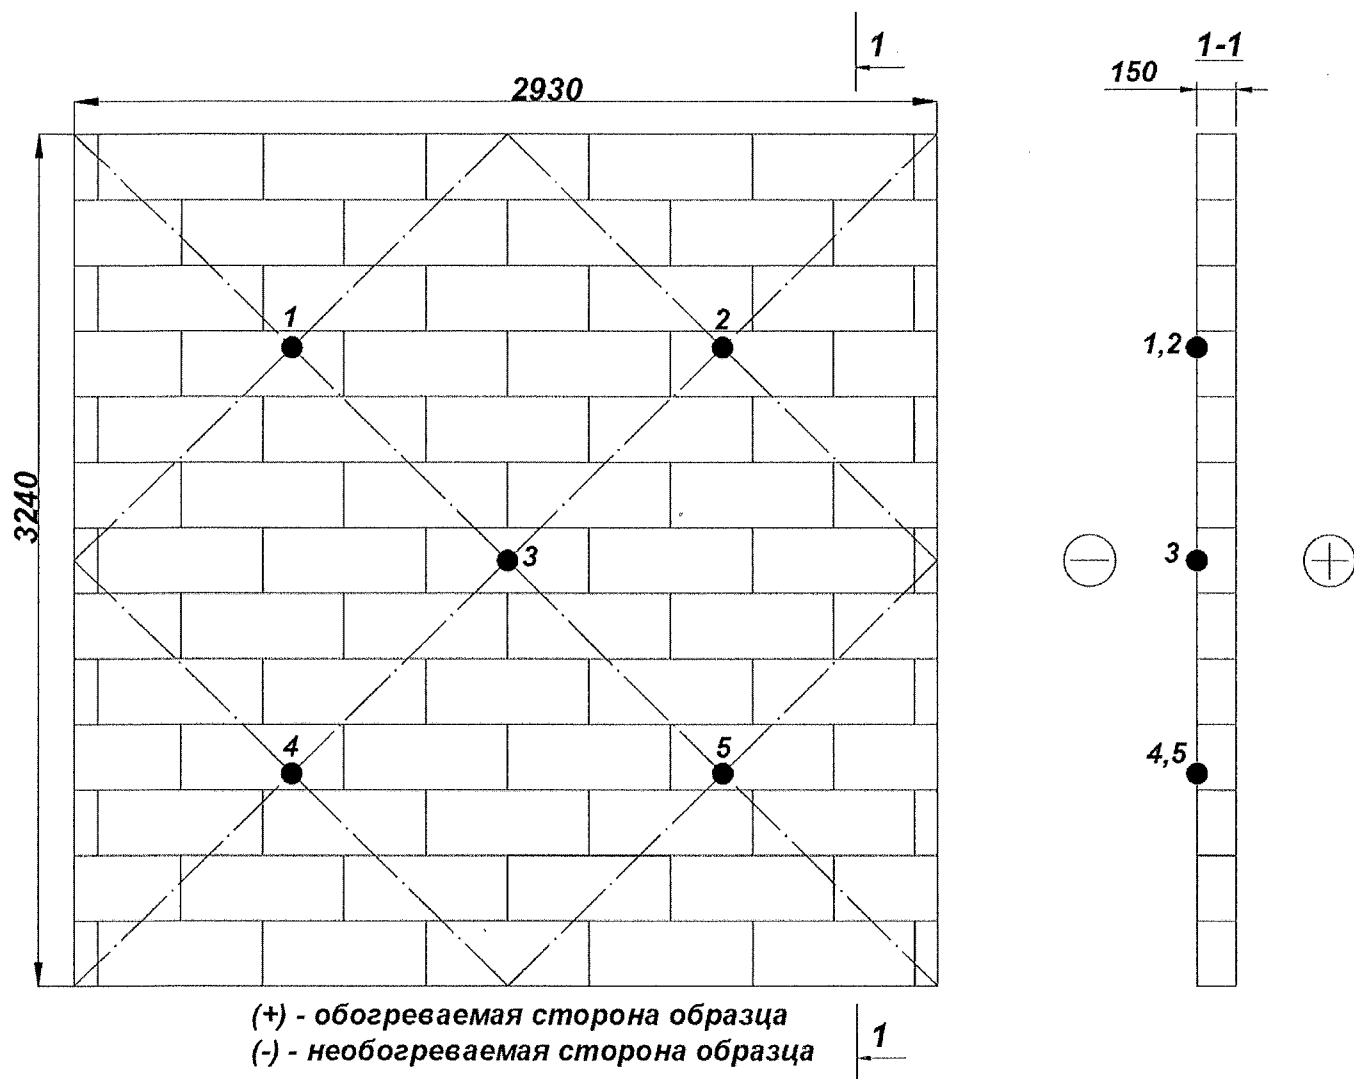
Общий вид образца и схема расстановки термодатчиков на необогреваемой поверхности образца.
